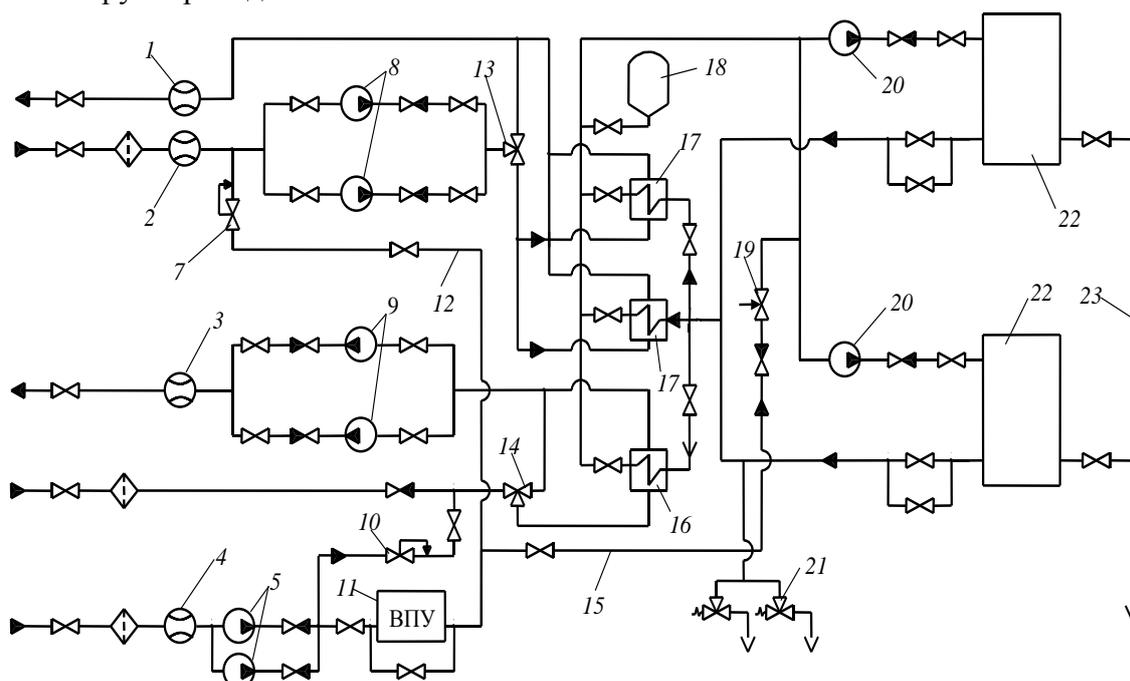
Схема трубопроводов котельной с разделительными теплообменниками
